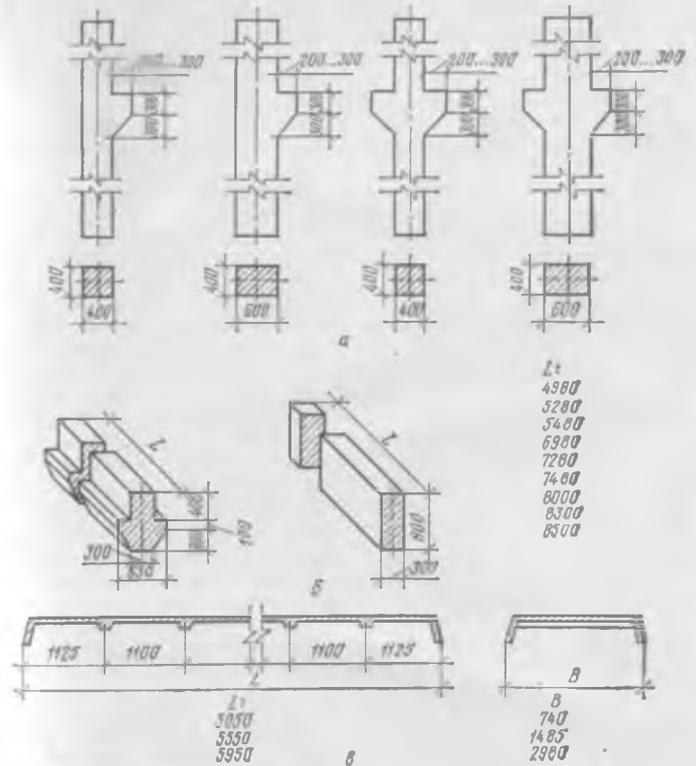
Элементы конструкции производственных зданий: а — колонны; б — ригели; в — плиты перекрытия
